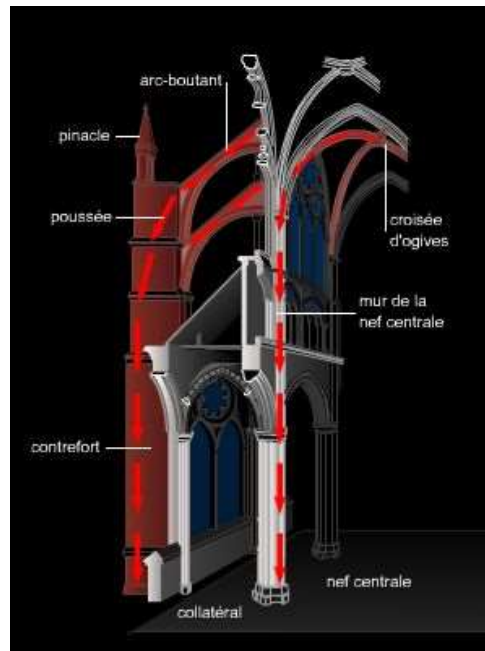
Construction gothique, croisée d'ogives et arc-boutant
